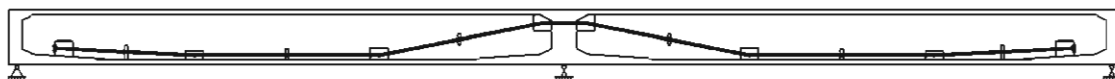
多跨连续布设体外预应力钢筋示意
